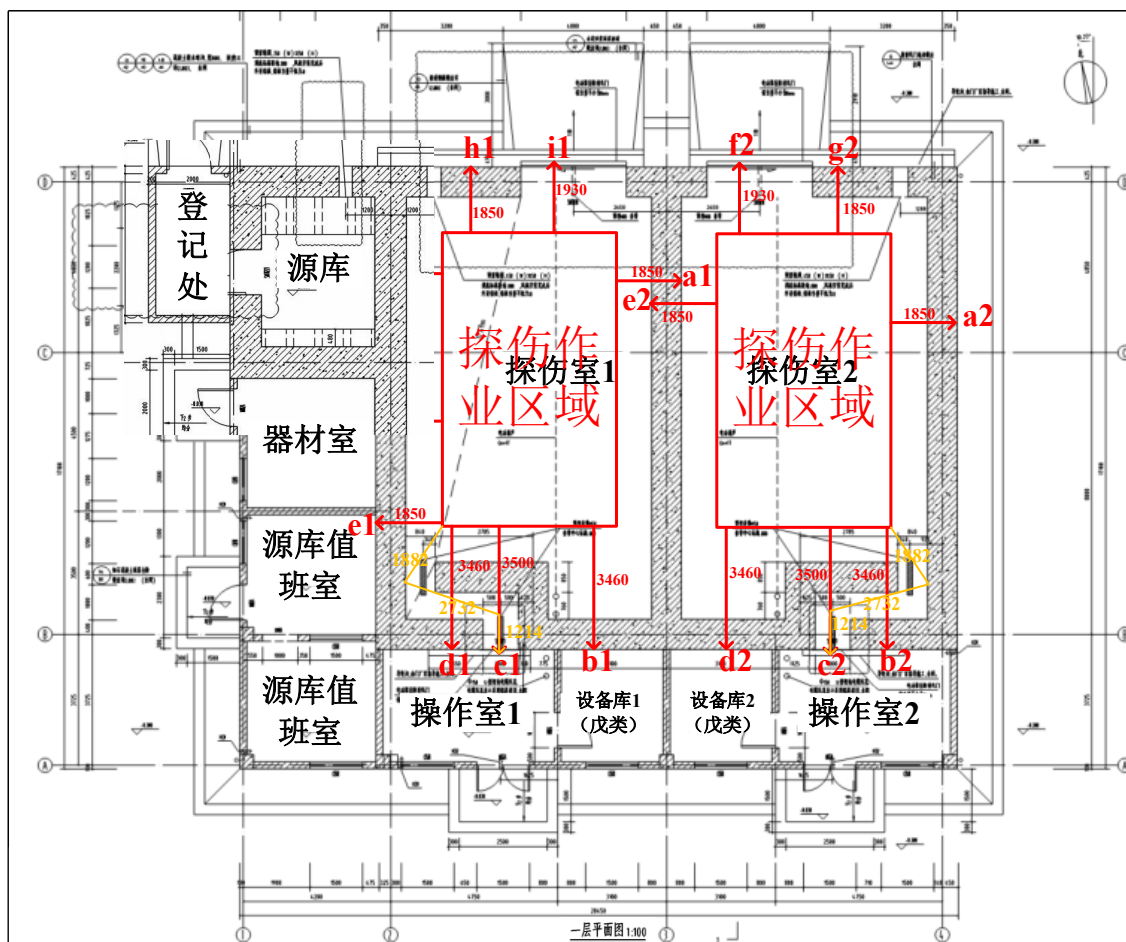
探伤室平面布置预测点位示意图 单位：mm
